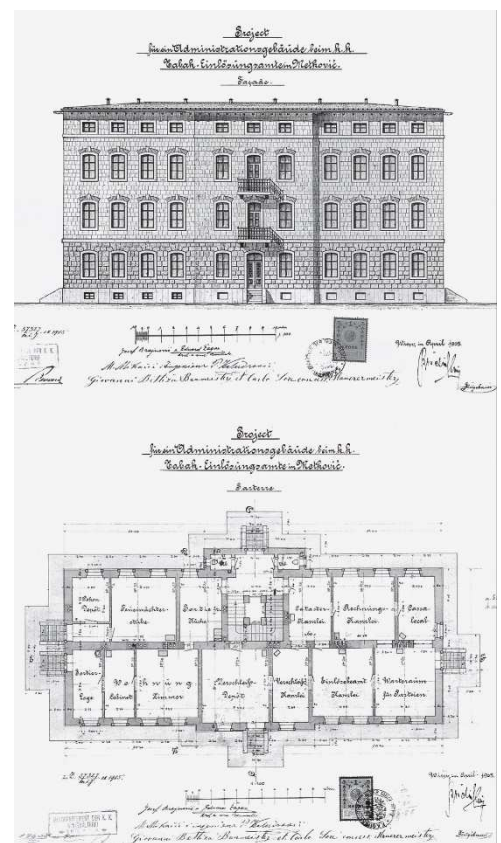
Grundriss, Verwaltungsgebäude in Metković, Ostfassade, 1906.
